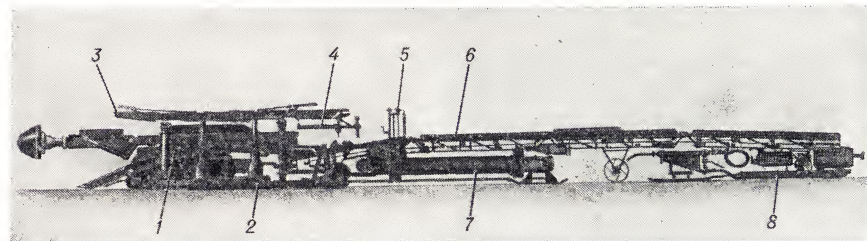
Проведение выработок комбайновым комплексом: 1 — проходческий комбайн; 2 — боковые секции крепи; 3 — перекрытие над комбайном; 4 — кассета для металлической сетки; 5 — бурильная установка для возведения анкерного крепления; 6 — перегружатель ленточный передвижной; 7 — пылеулавливающая установка; 8 — насосная установка.
